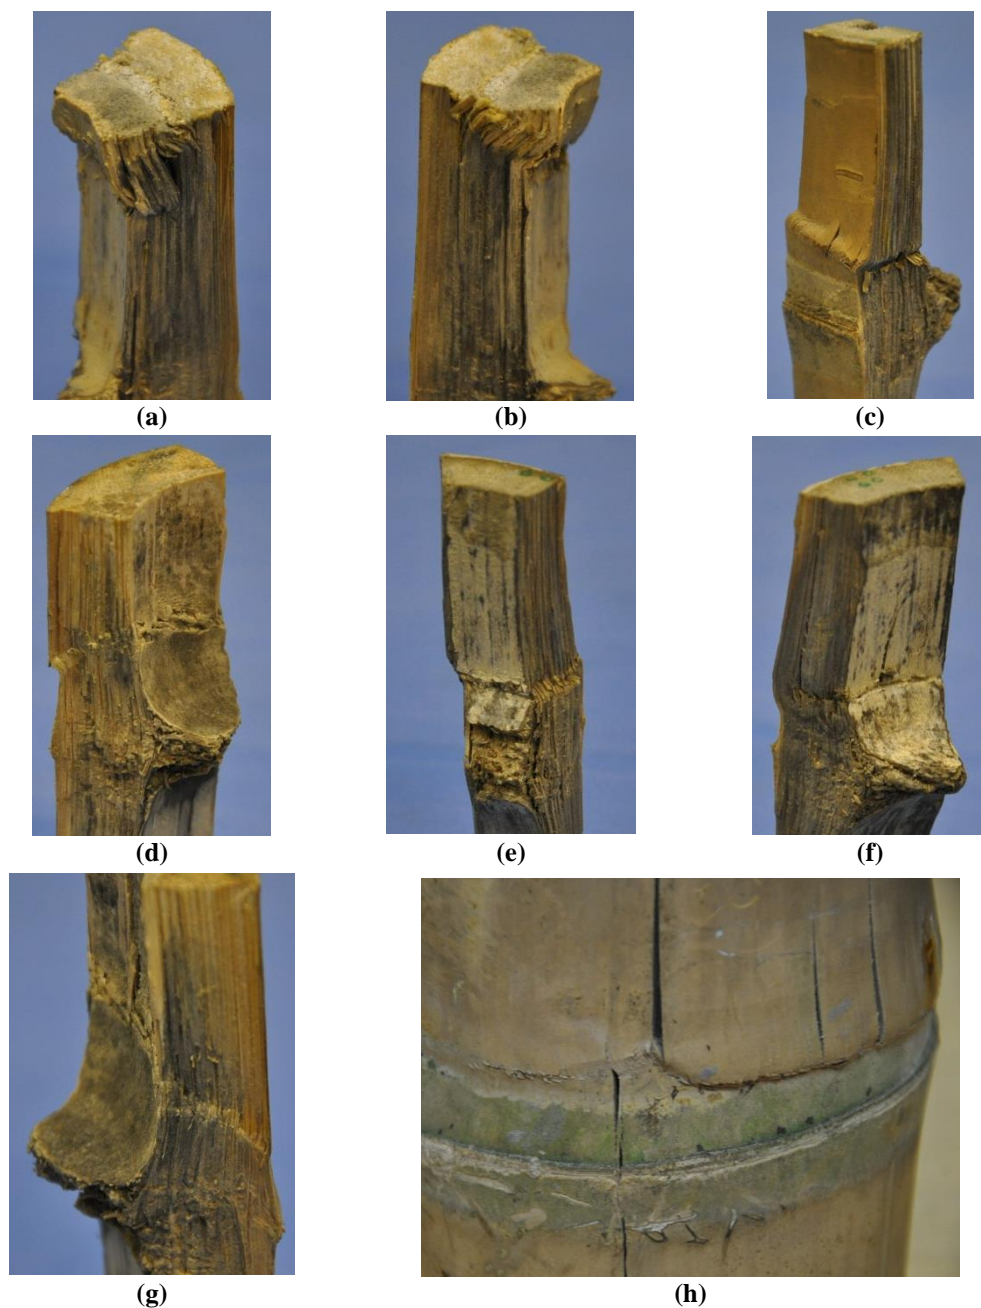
Amostras rompidas: a) e b) esmagamento de fibras na extremidade; c) a g) detalhes de falhas na região nodal; h) aparecimento de algumas fissuras longitudinais, apesar do modo de falha, predominante, ser nodal.
